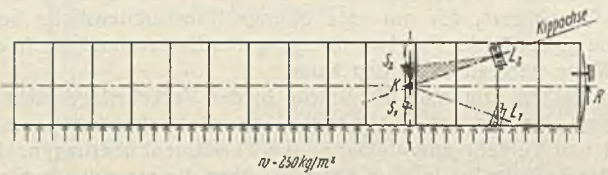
Lagerung der Brücke in Drehlage, Ausnahmefall.
